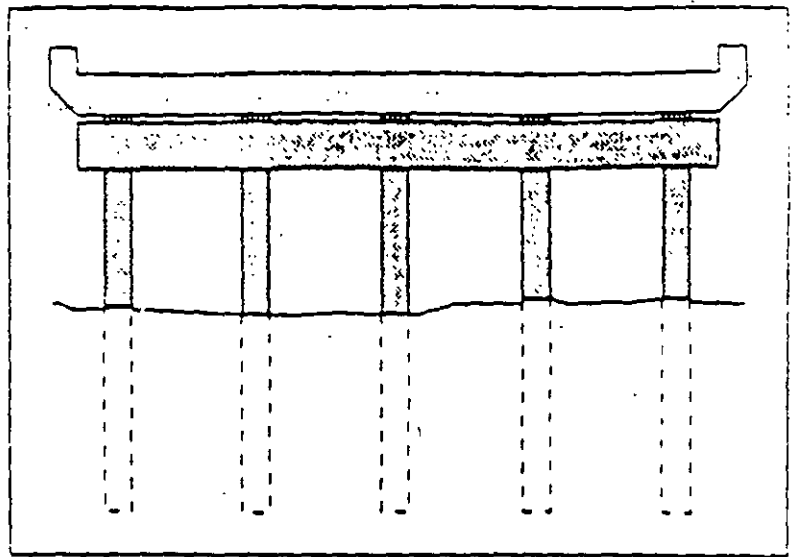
Pila, tipo 40, pilotes con cabezal
